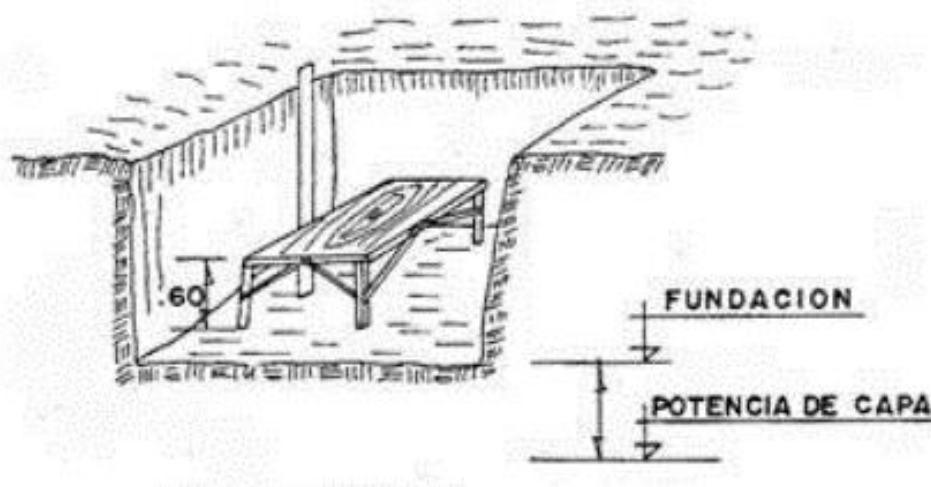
Colocación de mesa para prueba del terreno. Fuente: civilgeeks
